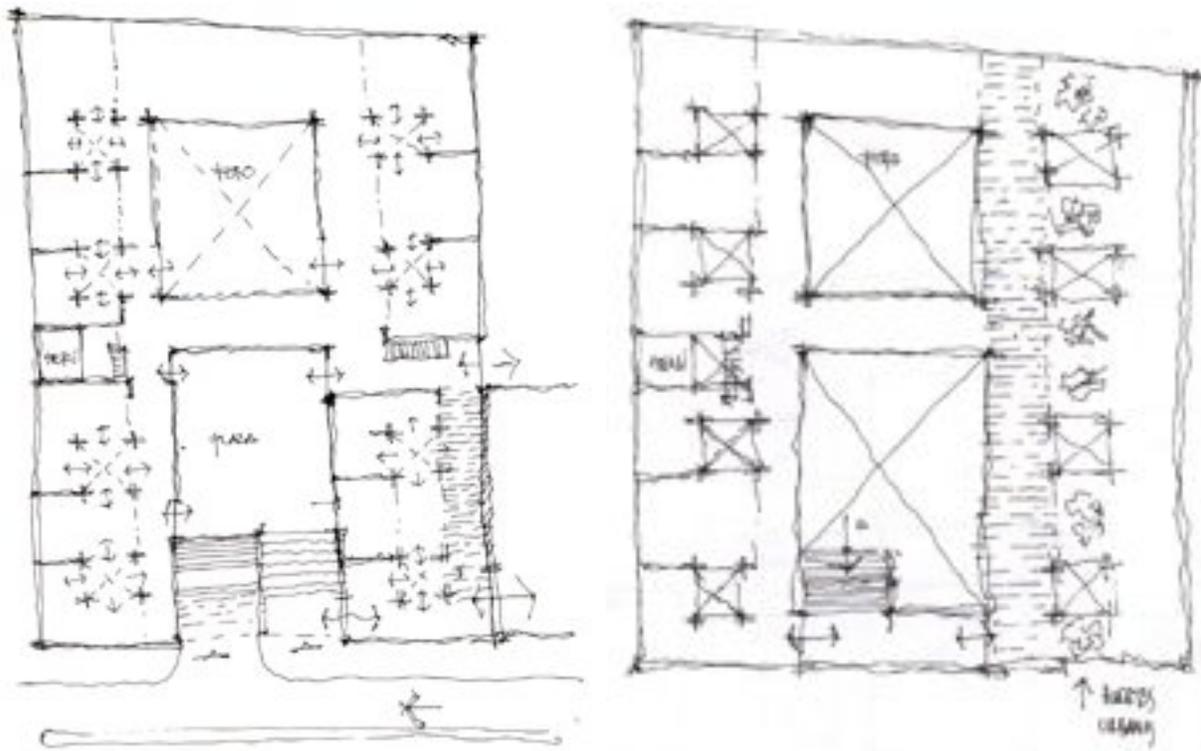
Croquis de zonificación preliminar en planta baja y planta alta.
